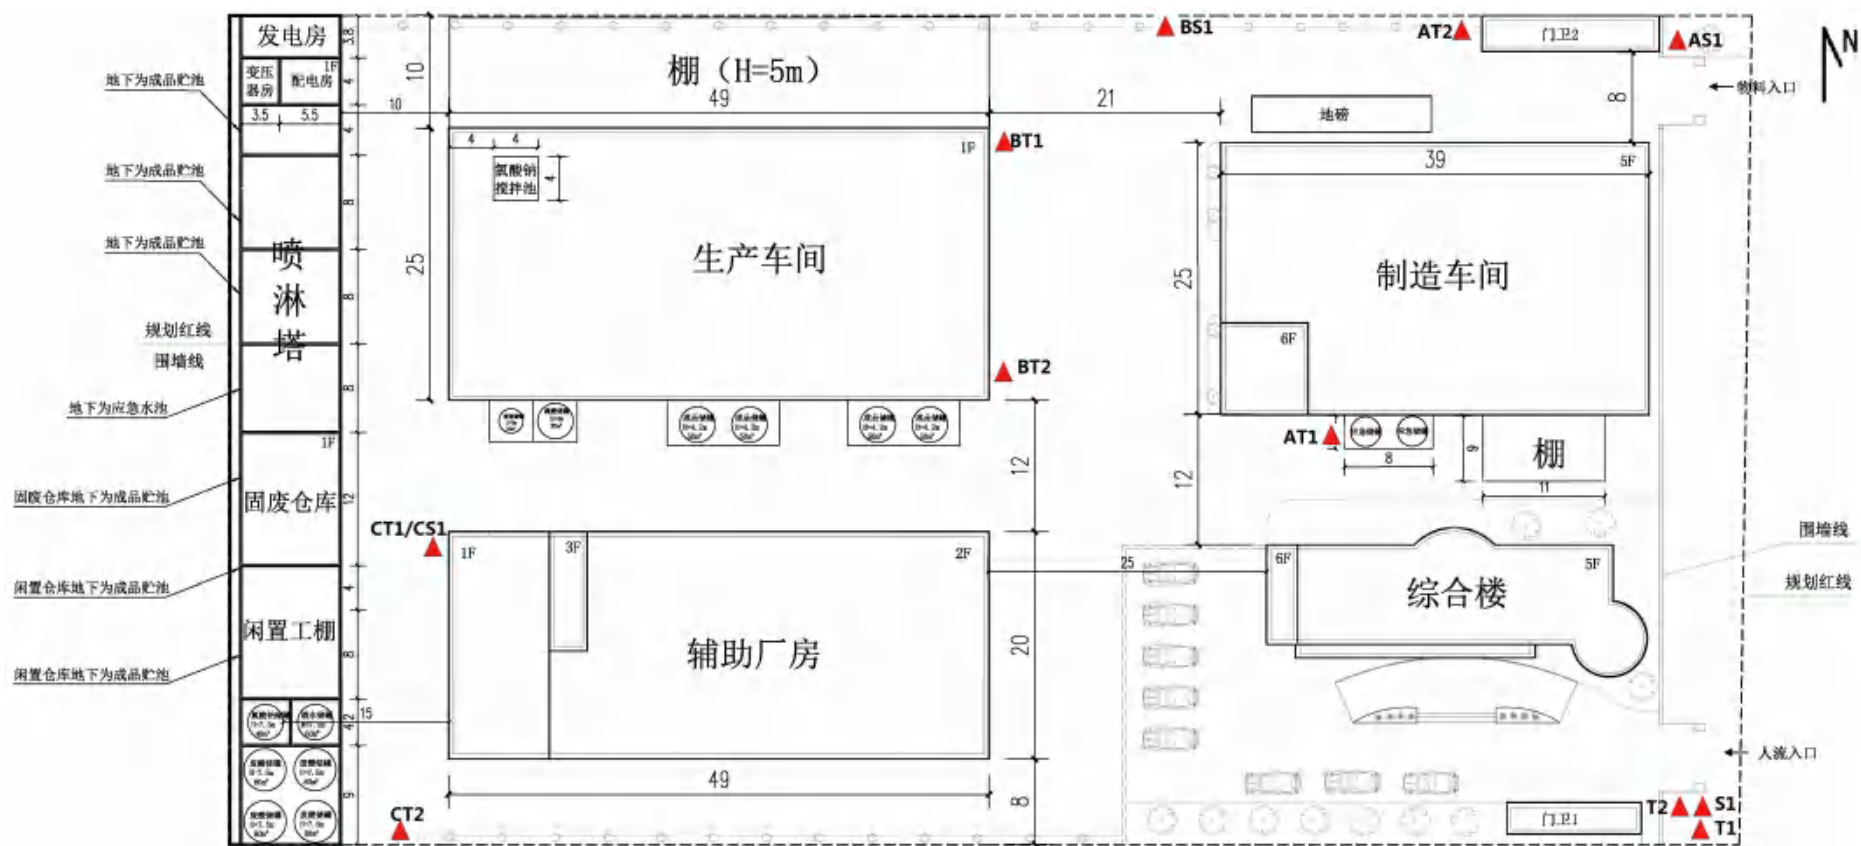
诚洁及鸿泉采样点布置图（平面布置图）
